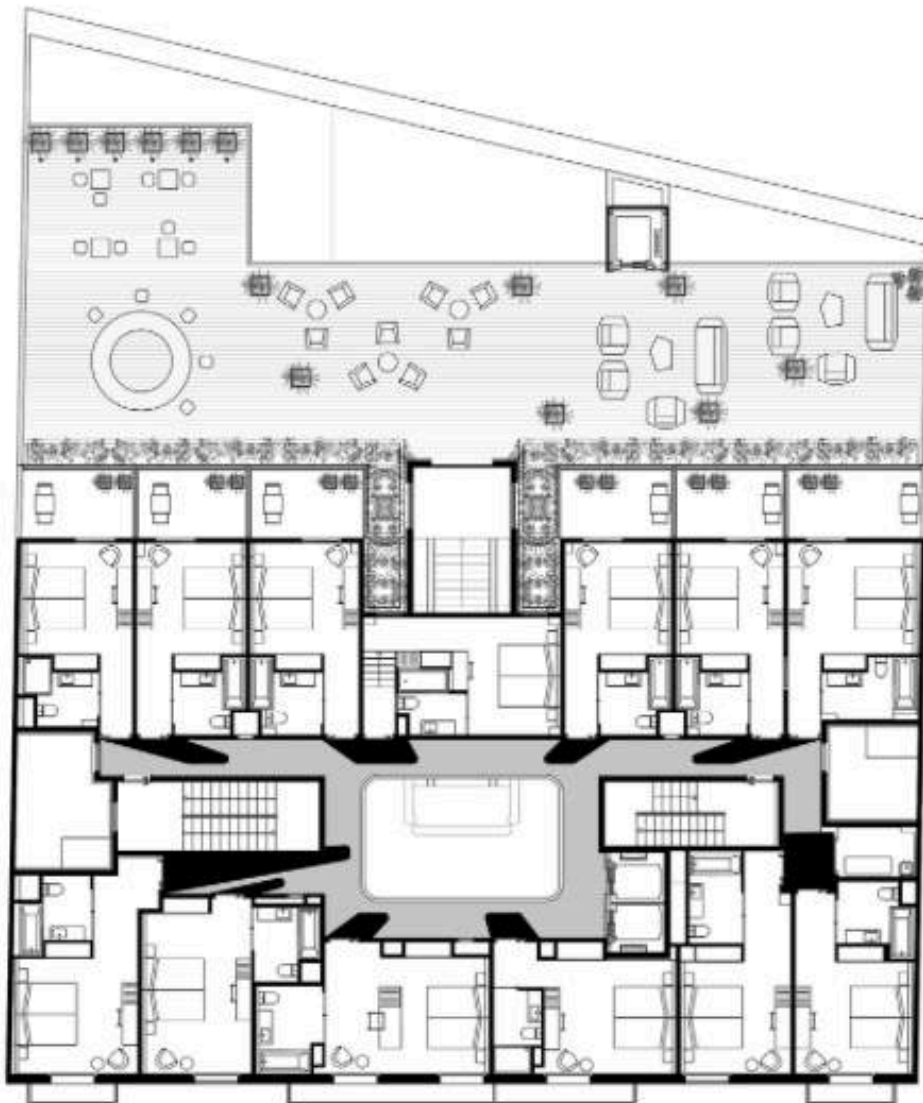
Planta do piso I do Hotel Vincci Gala, sem escala nem Norte
